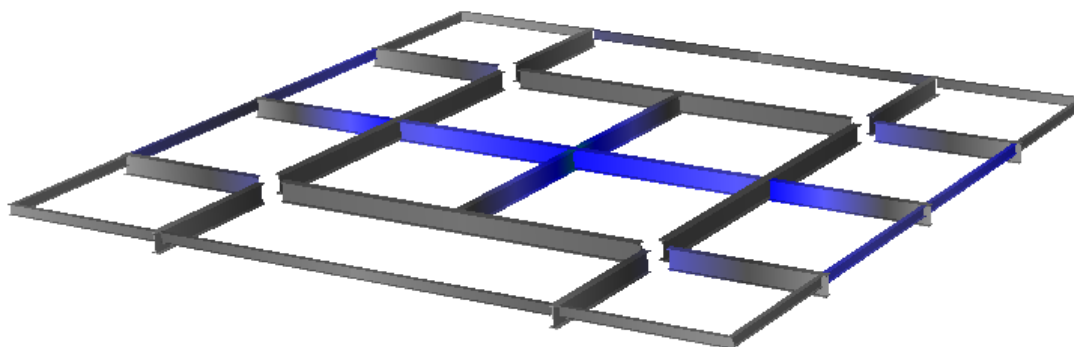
Elementi orizzontali a sezione aperta e boxata - impalcato Quota 22 m (copertura)
